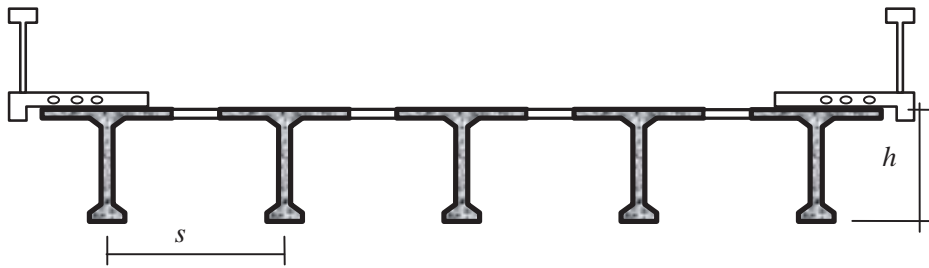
esquema de una losa apoyada sobre vigas con sección tipo Guyon
